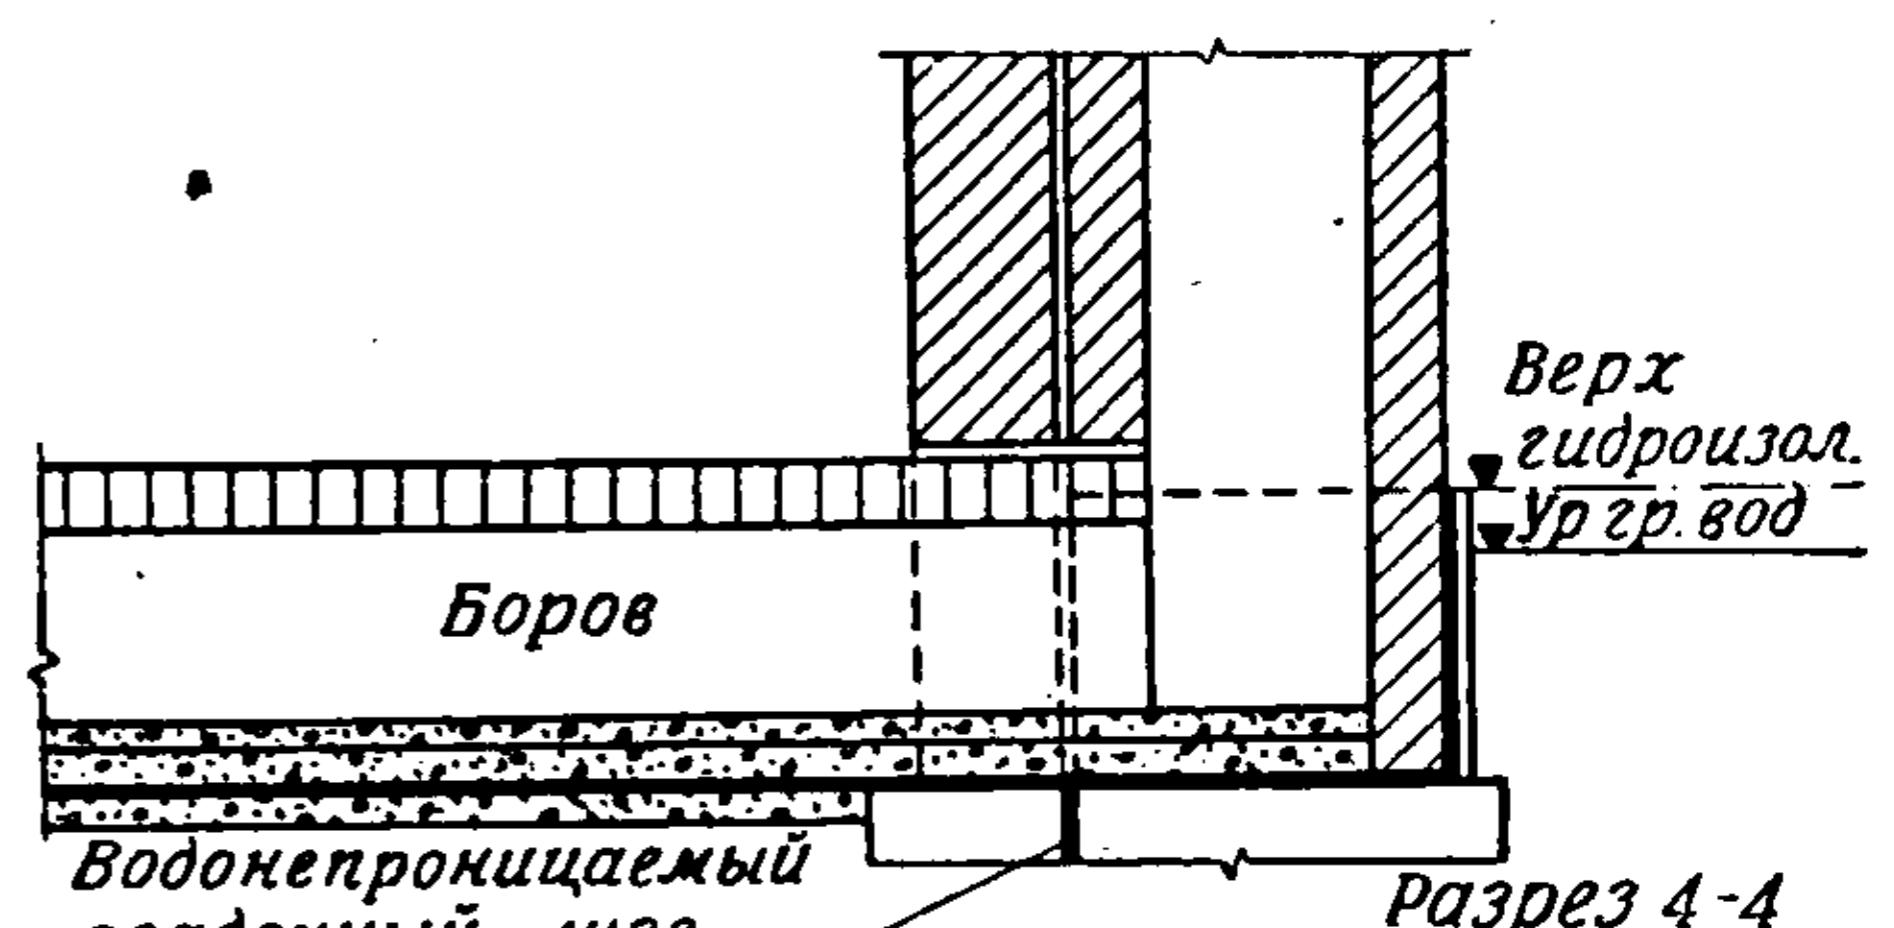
Изоляция узла А в месте примыкания внешней стены
